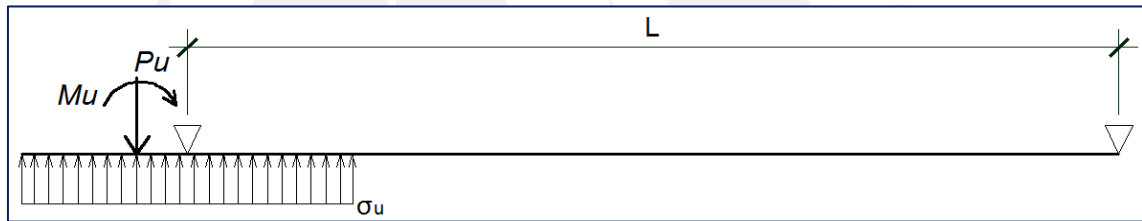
Modelación de zapata excéntrica y viga conectada
